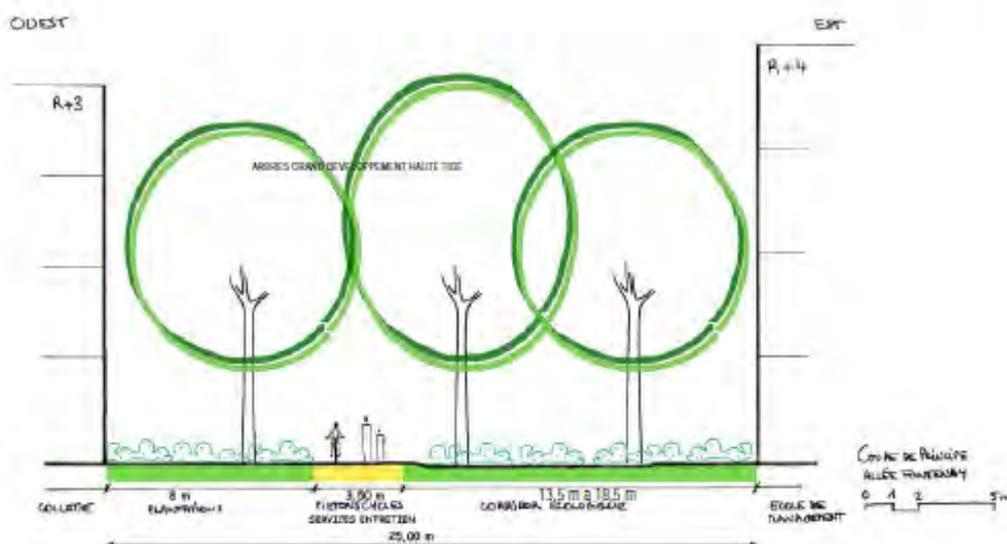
coupe de principe de l'Allée Fontenay. Atelier Marguerit
